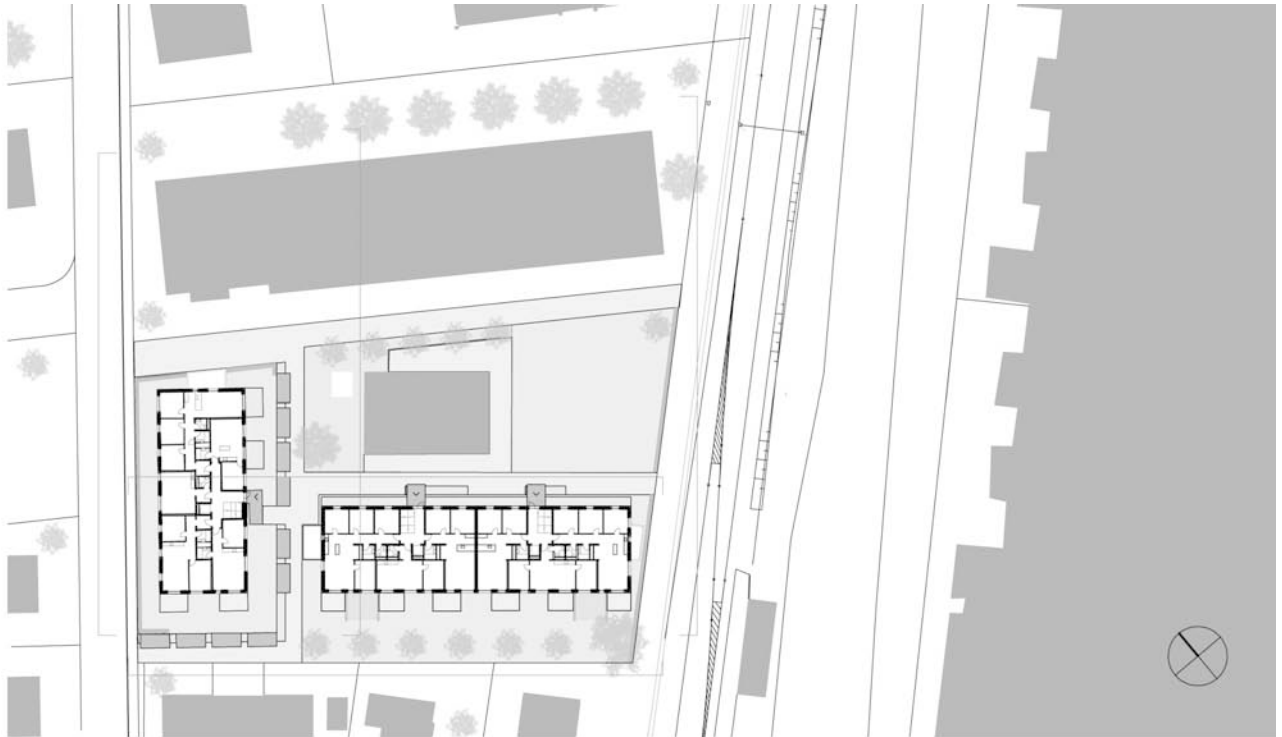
Normalgrundriss Haus B (links) und Haus A, bestehendes Hofhaus mit Umgebung 1:1000
